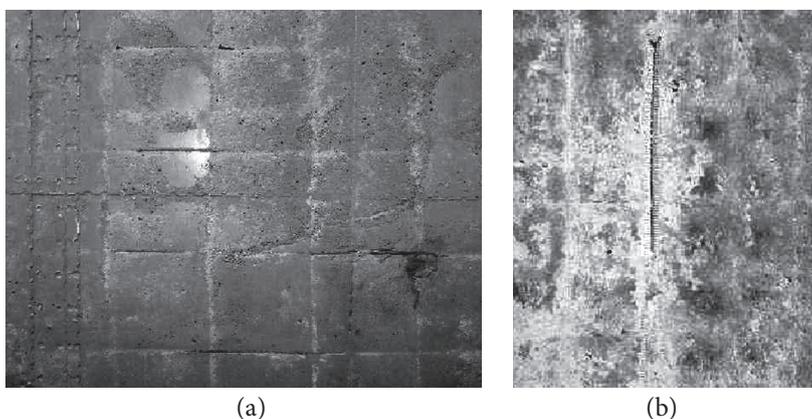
Problemas pós-concretagem: (a) exposição da armadura após concretagem; (b) exposição de instalação elétrica após concretagem
